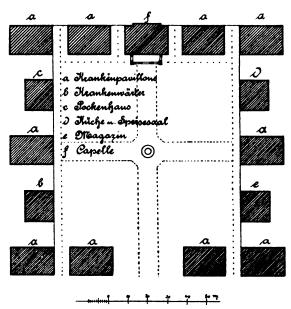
Plan des Hospitals su Stonchouse bei Plymouth.
